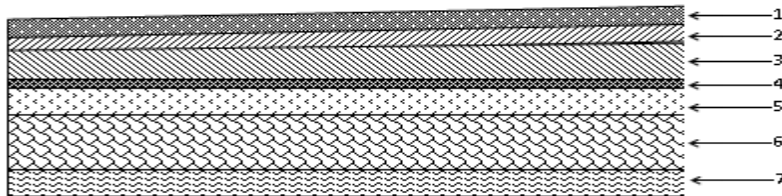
Coupe transversale du plancher terrasse inaccessible.
